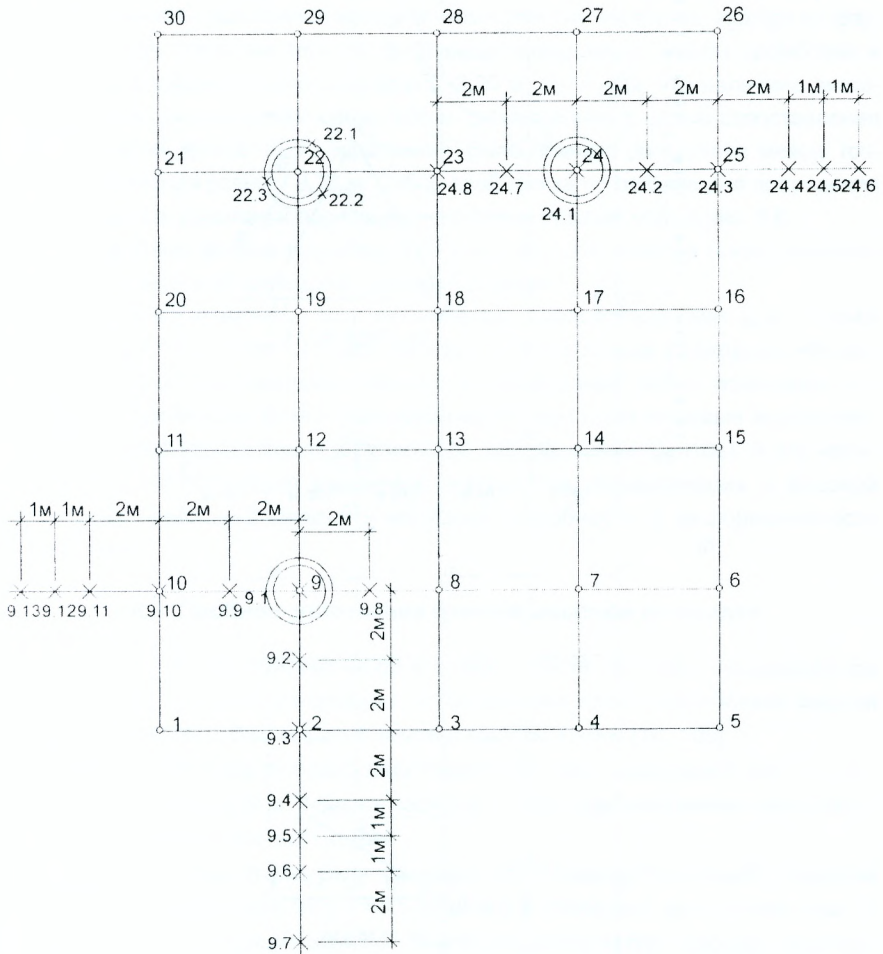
Квадратная схема отбора проб грунта, испытания штампами и зондированием опытной площадки
